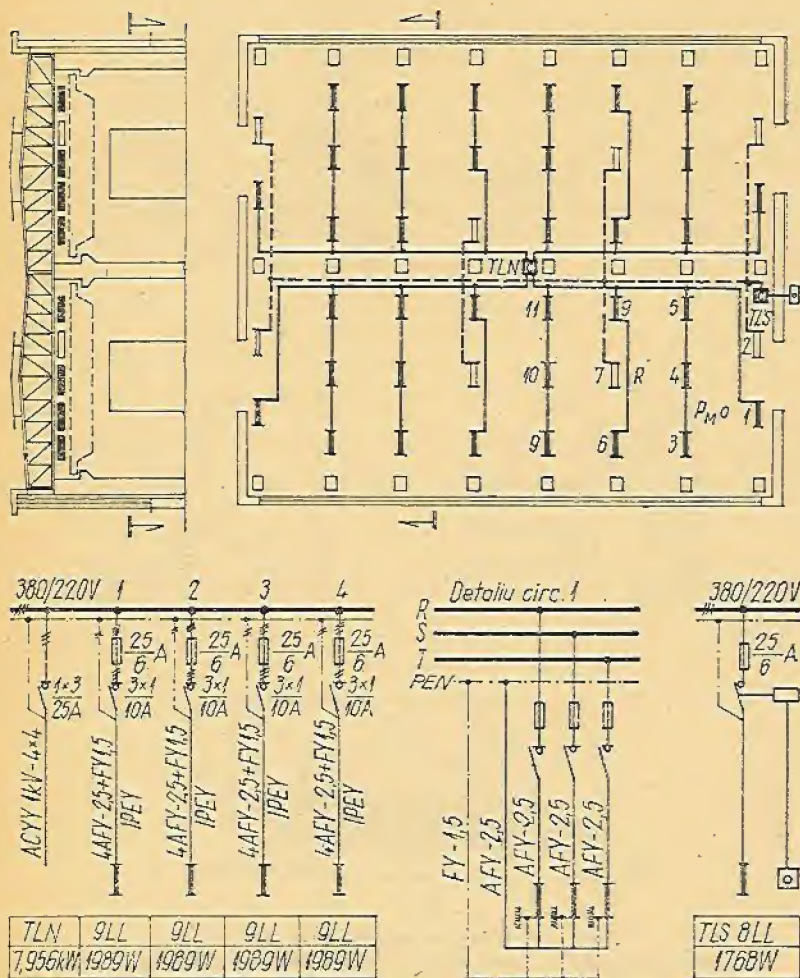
Planul și schema instalației de iluminat a unei hale industriale.
